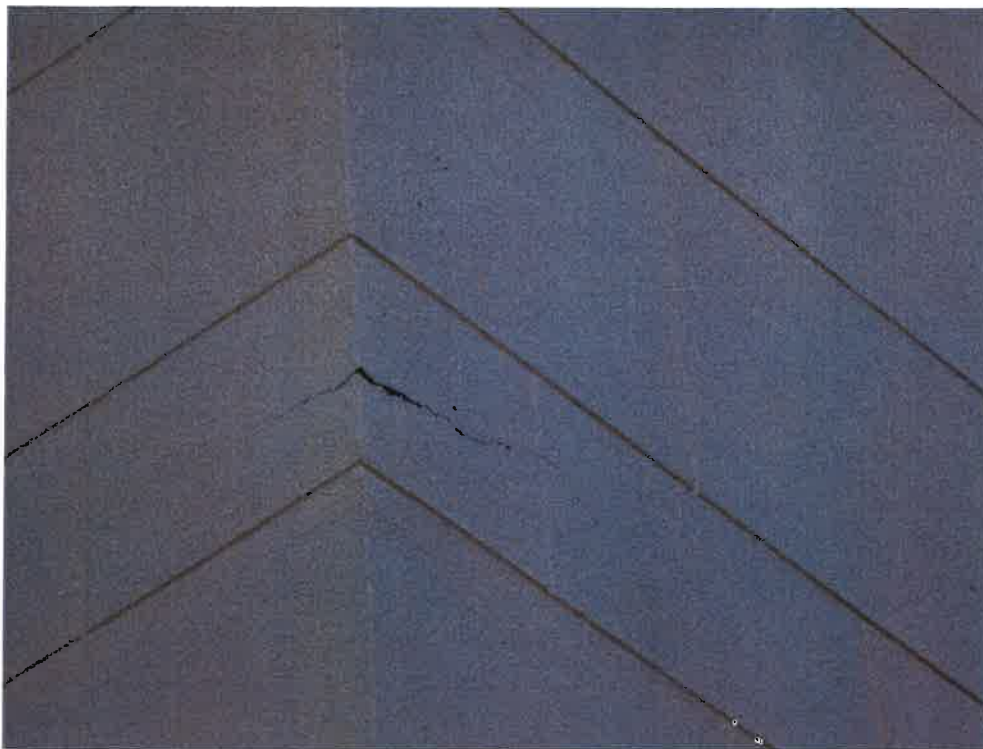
Fenda no cunhal entre o alçado principal e o alçado lateral direito, ao nível do 2º piso(tecto)
